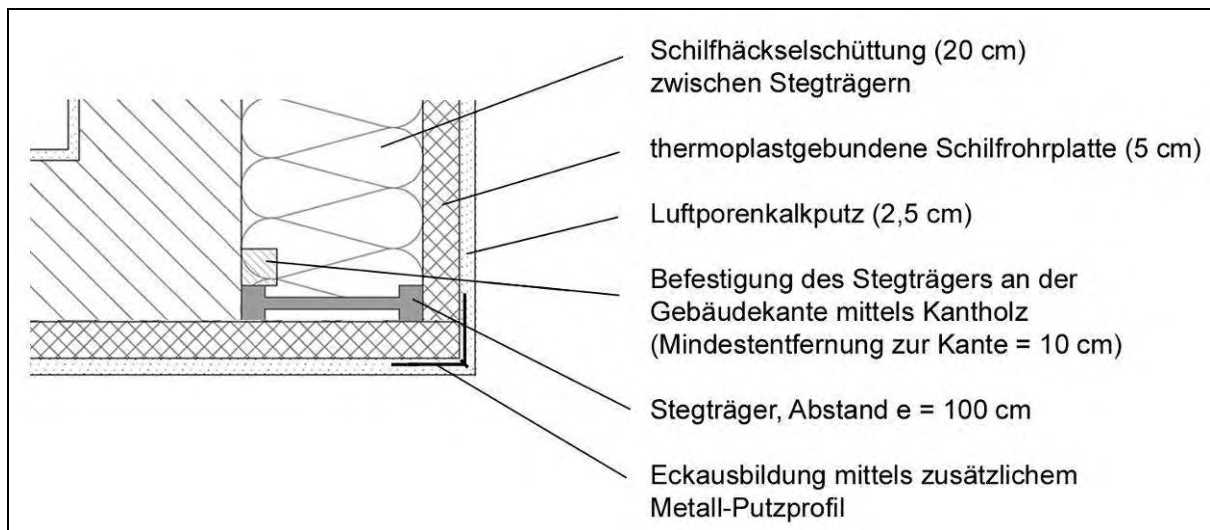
Anschlussdetail horizontaler Systemwechsel an Gebäudekante
